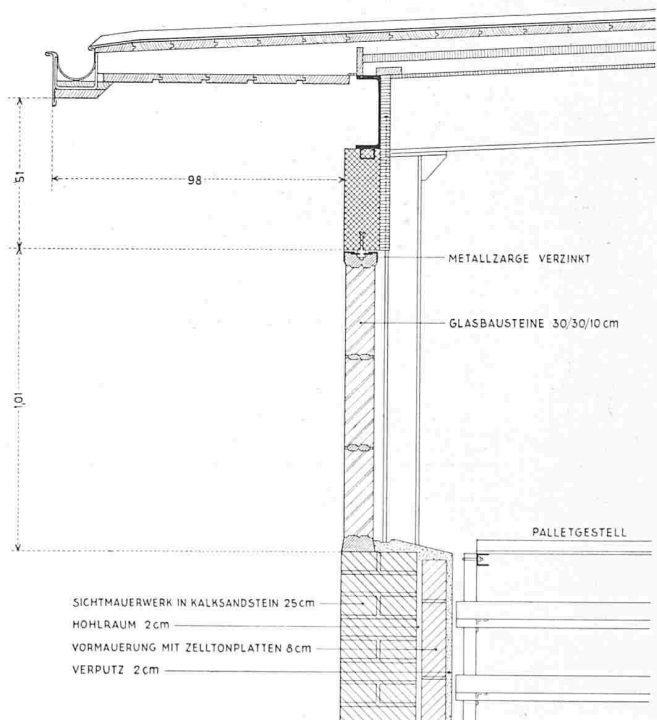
Papierlager, Schnitt 1 : 25 der Westfassade
